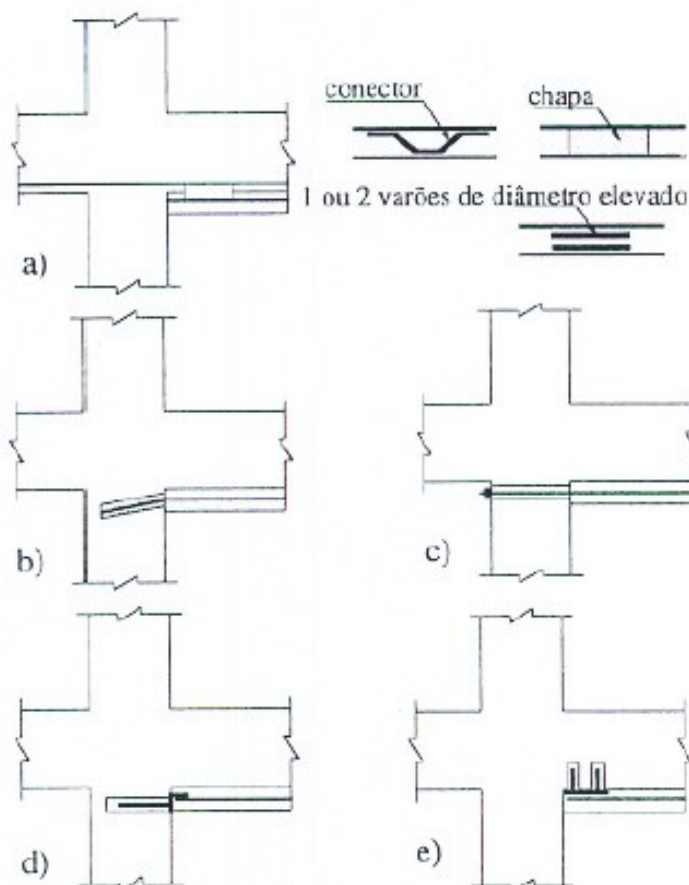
Detalhe da seção de uma viga reforçada com enchimento de concreto.
